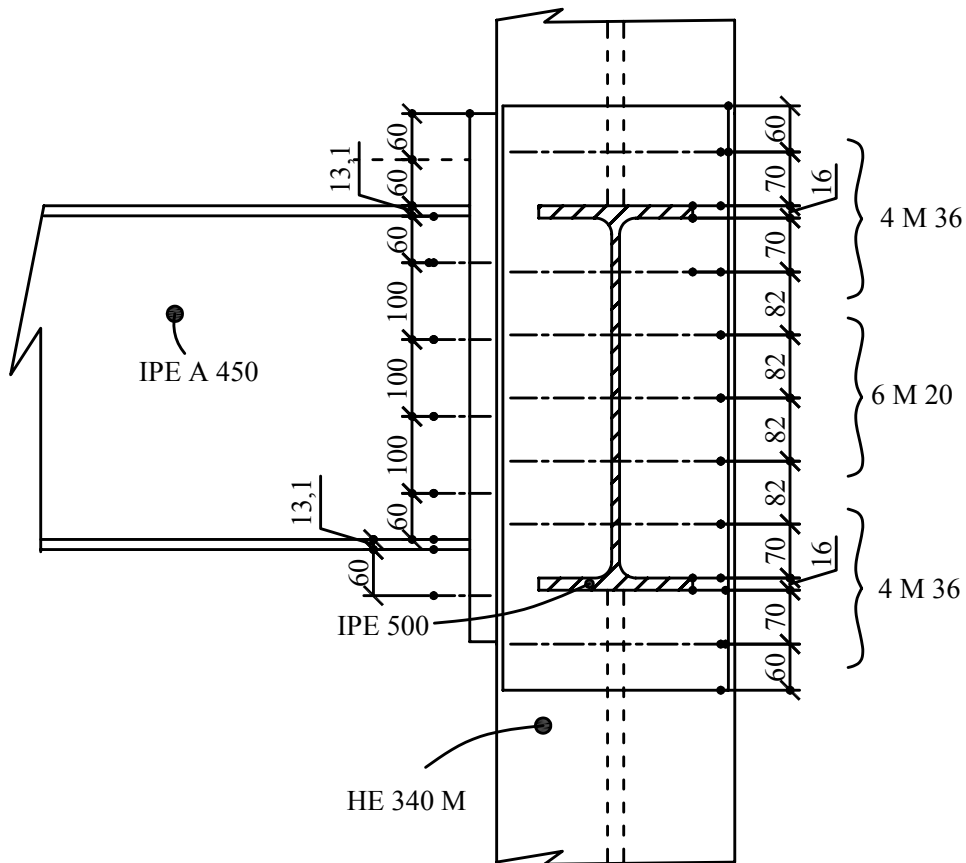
Vue en élévation de l'assemblage poutre – poteau à un nœud de façade.
